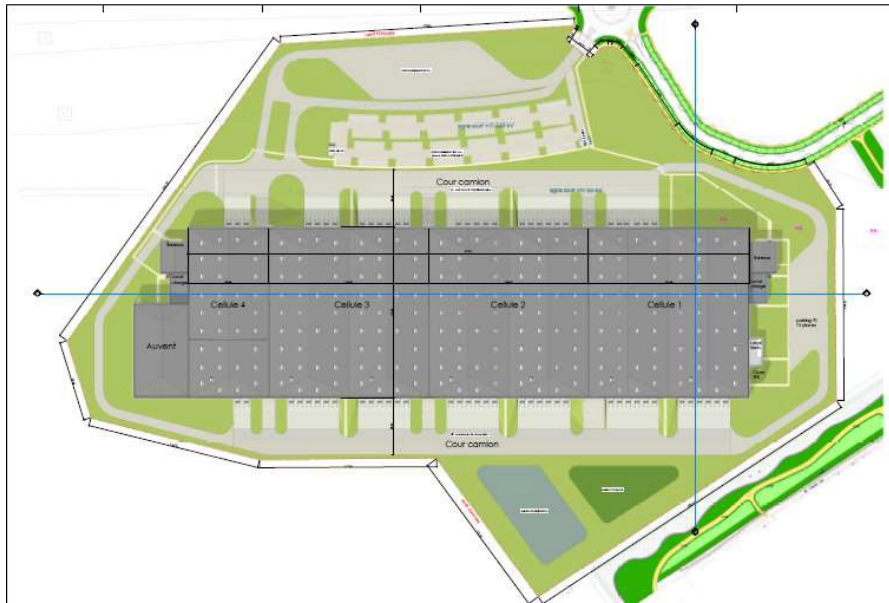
Plan d'ensemble du site et du bâtiment projeté
